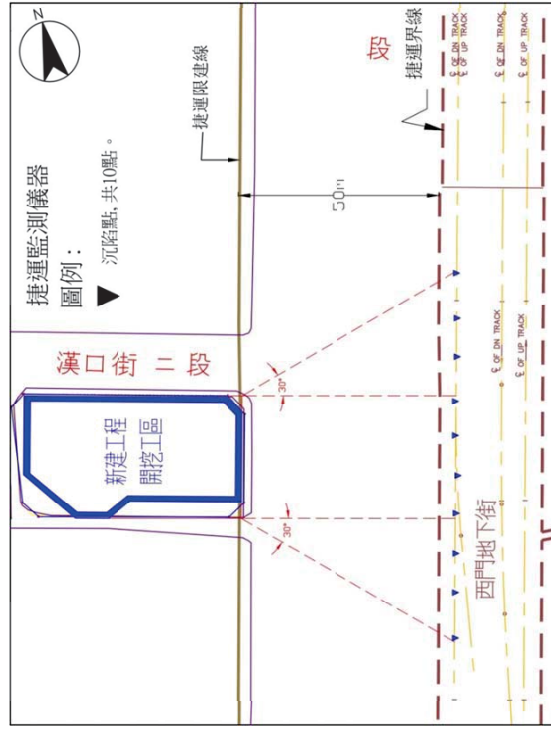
捷運設施監測儀器佈設範圍及儀器配置平面示意圖
